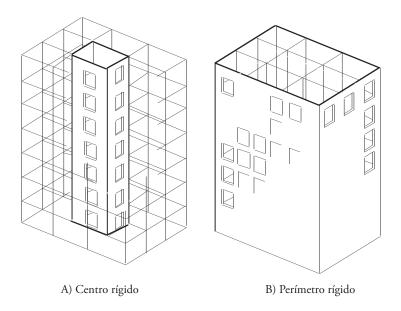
Edificio de altura con centro o perímetro rígido (Allen, 1985).
